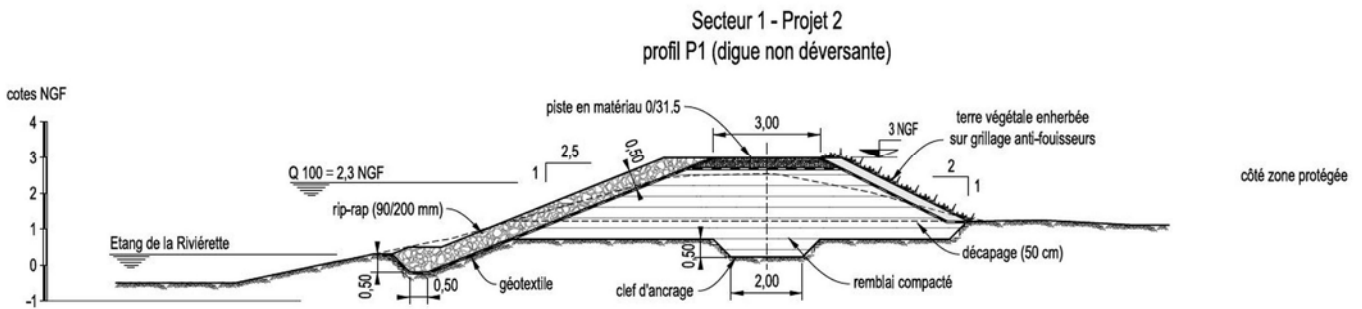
COUPE-TYPE D'UNE SECTION RENFORCEE SUR LE TALUS AMONT
